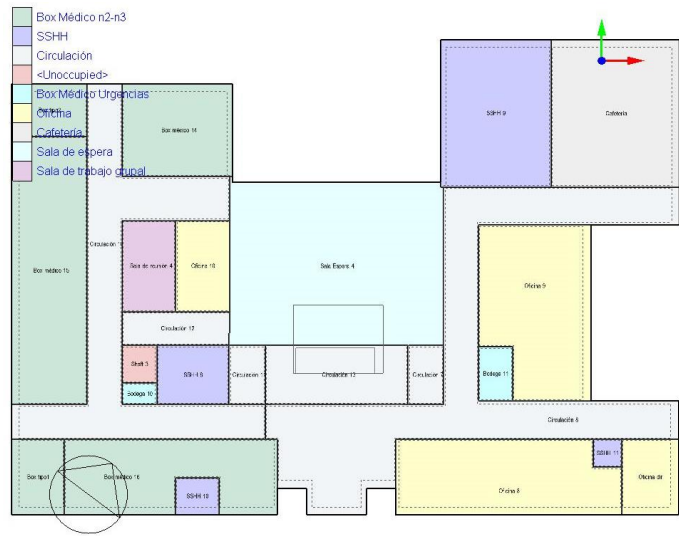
Planta Nivel 3 - Zonas Térmicas
